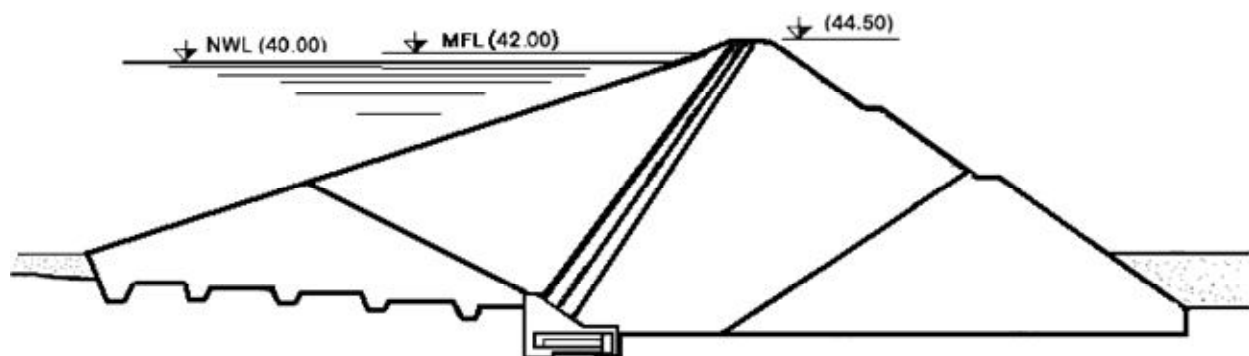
coupe transversale du barrage de Vale de Gaio
